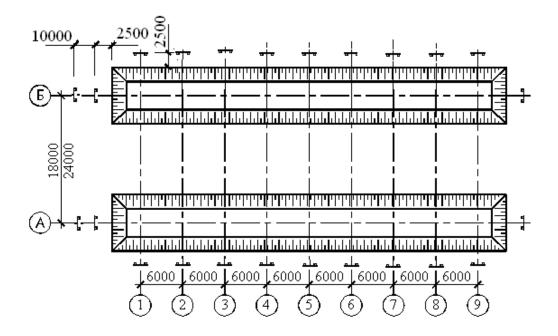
Схема устройства траншей под фундаменты здания при пролетах 18 и 24 м
